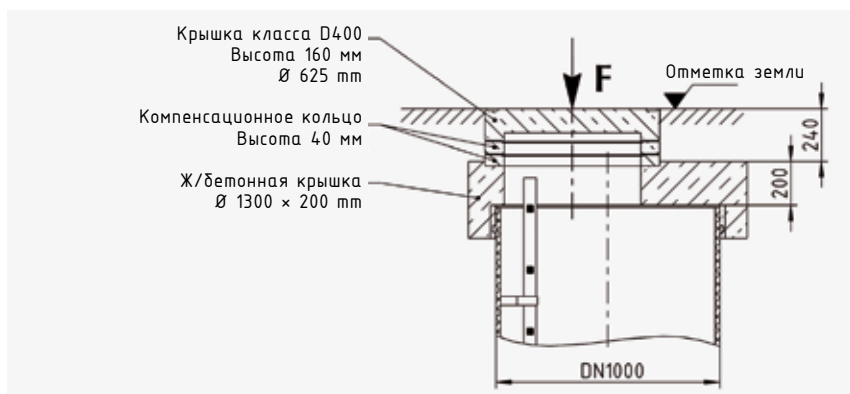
| Крышка с полусоединением без разгрузочного кольца
